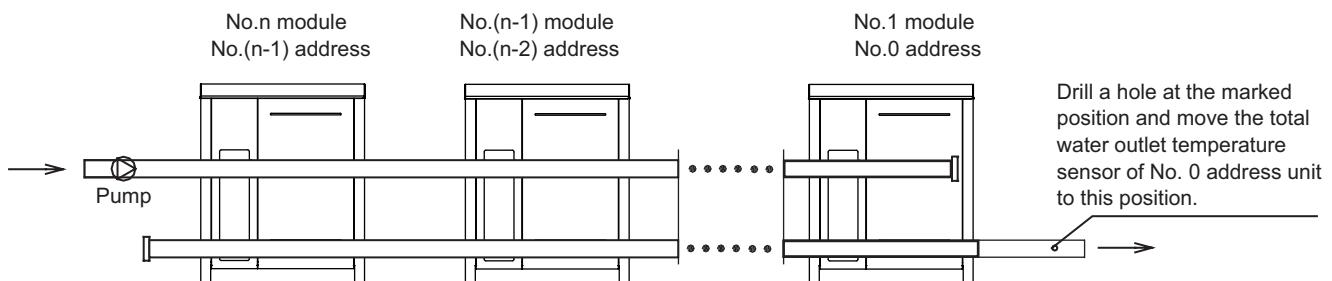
Installazione di un sistema a più moduli (non più di 16)
